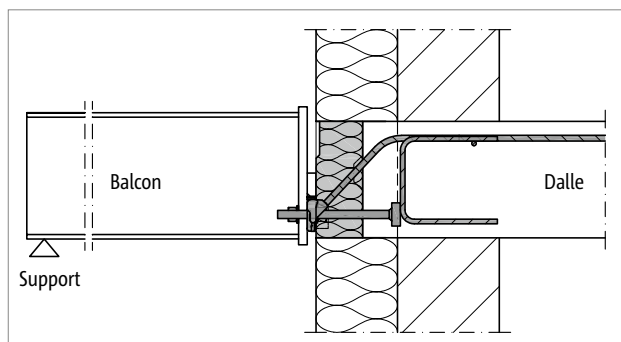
Schöck Isokorb® T type SQ : Grâce à la saillie du plancher, l'extérieur du corps isolant affleure l'isolation du mur, tout en tenant compte des distances par rapport aux bords latéraux
